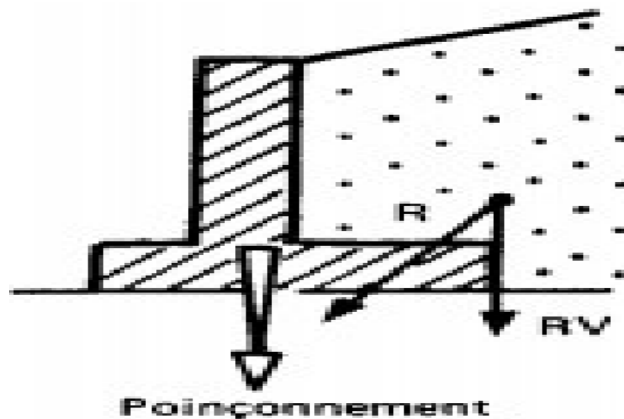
Stabilité au poinçonnement d'un mur de soutènement [16].
